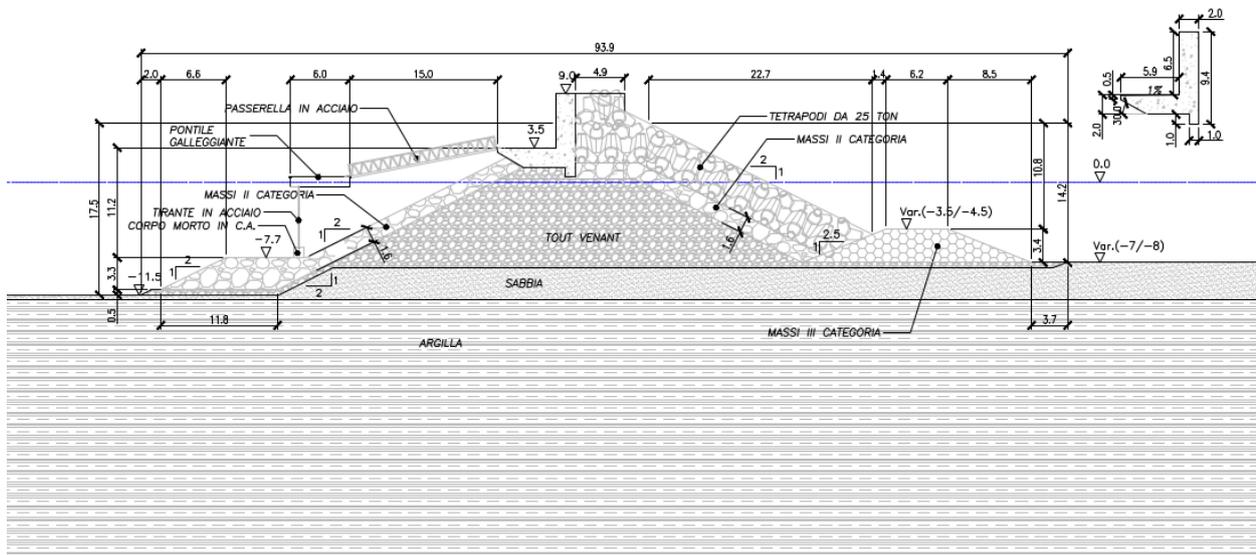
Sezione molo traiano sezione non tracimabile con ormeggi (Sez. A1)
